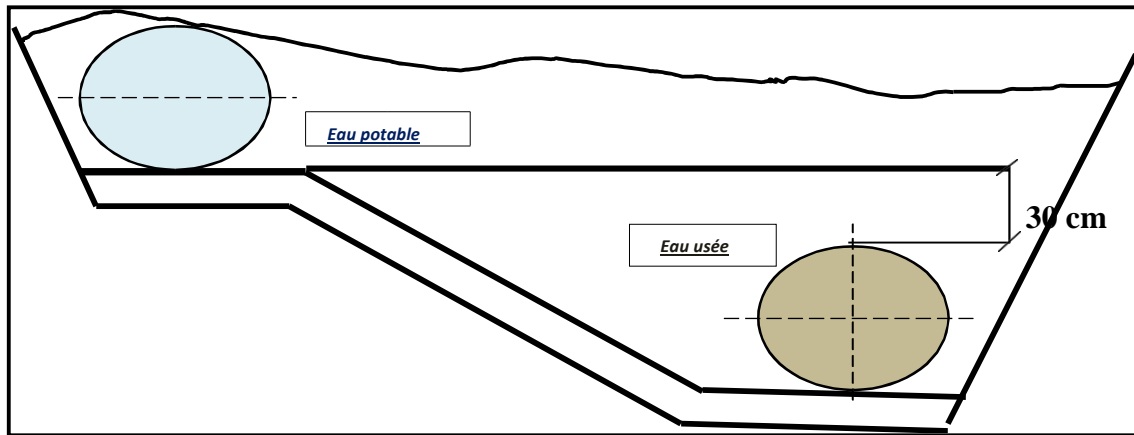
Pose à proximité d'une conduite d'assainissement
